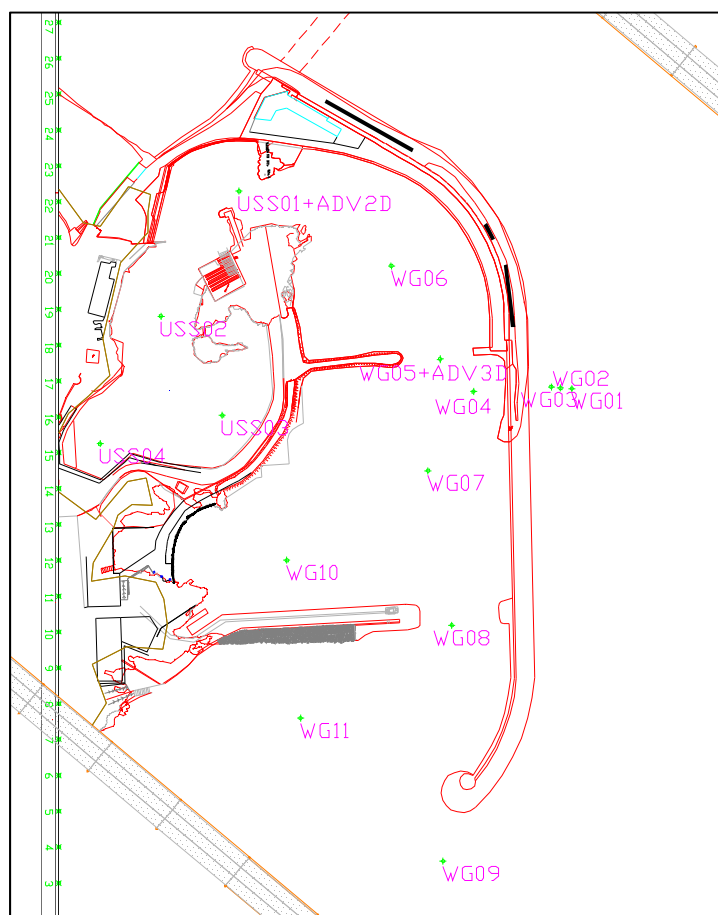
planimetria del porto con l'ubicazione e numerazione delle sonde di misura.
